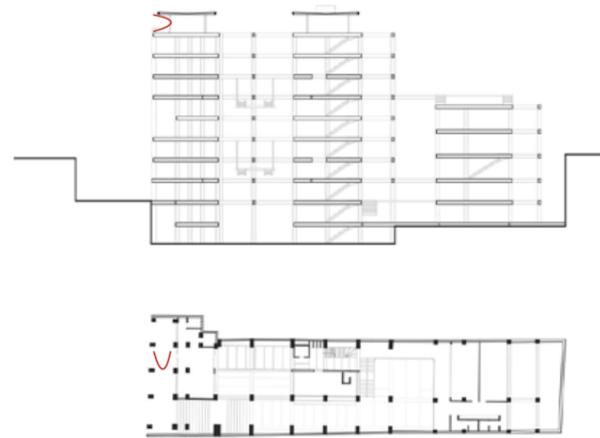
Detalle constructivo 4. Fuente: Elaboración propia.
